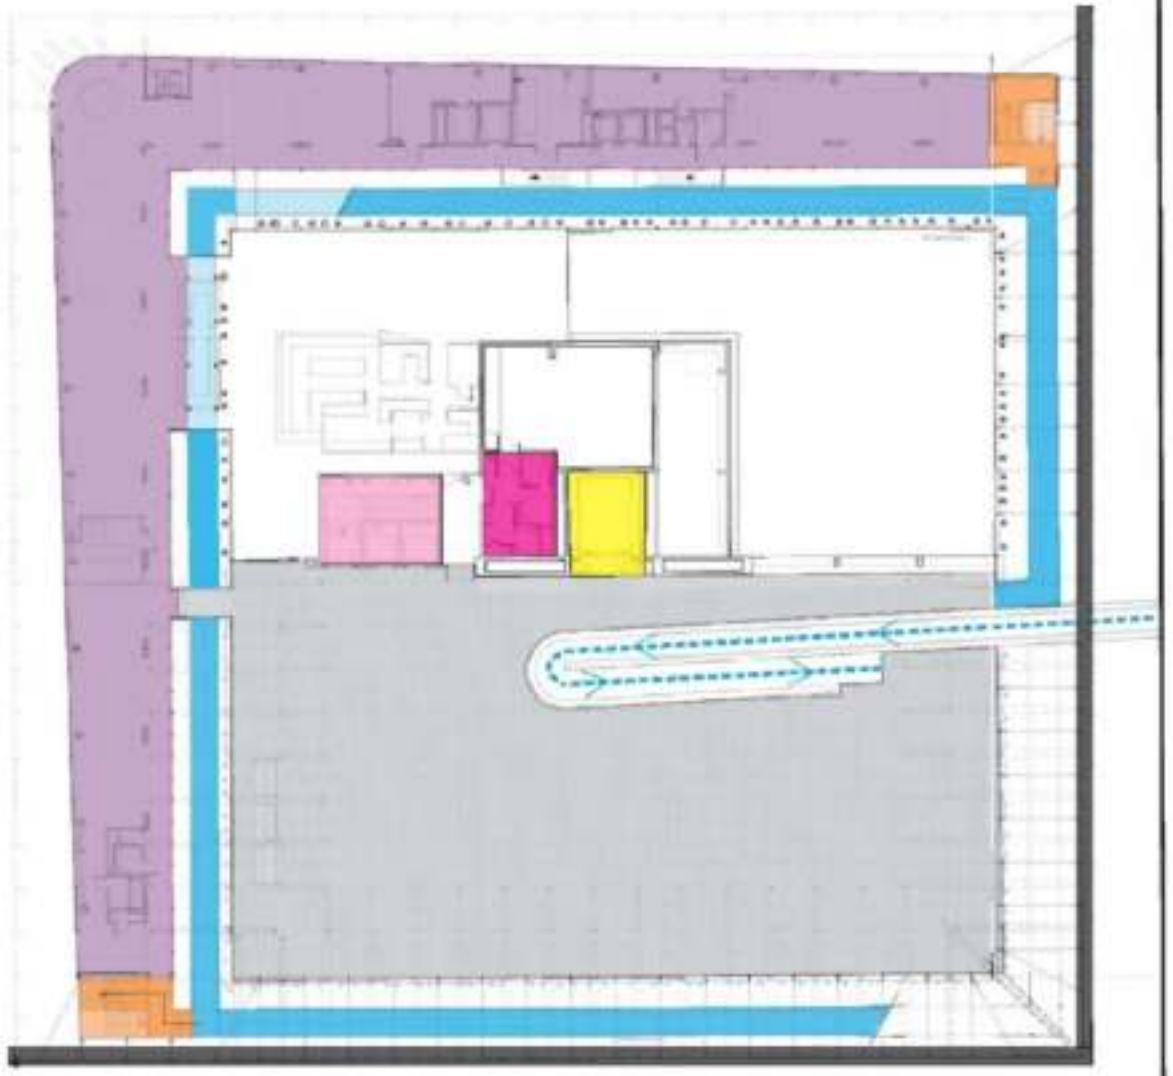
, Planta cuarto piso museo de las civilizaciones de Europa
